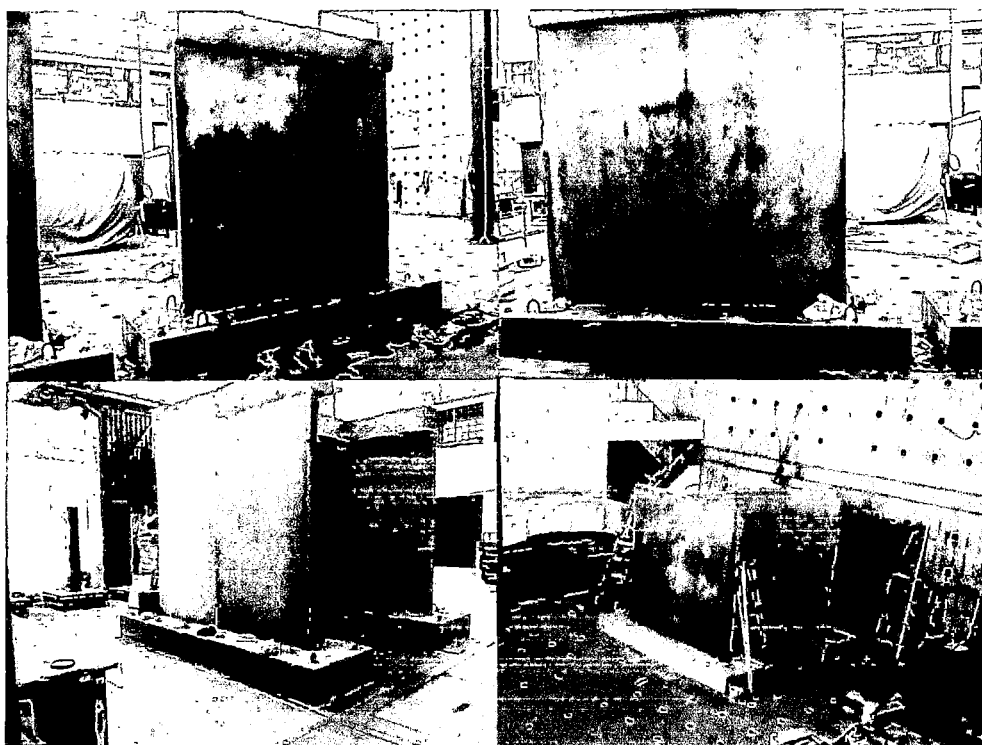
Especímenes desencofrados. De izquierda derecha y de arriba hacia abajo: muro 01, 02, 03 y 04.
